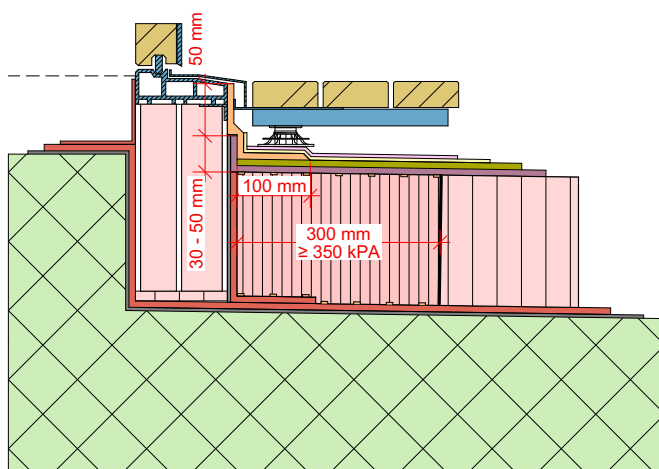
Raccordement PL sur étanchéité bitumineuse en deux couches pour raccordement de seuil, hauteur de raccordement au-dessus de la couche d'usure inférieure à 60 millimètres.
